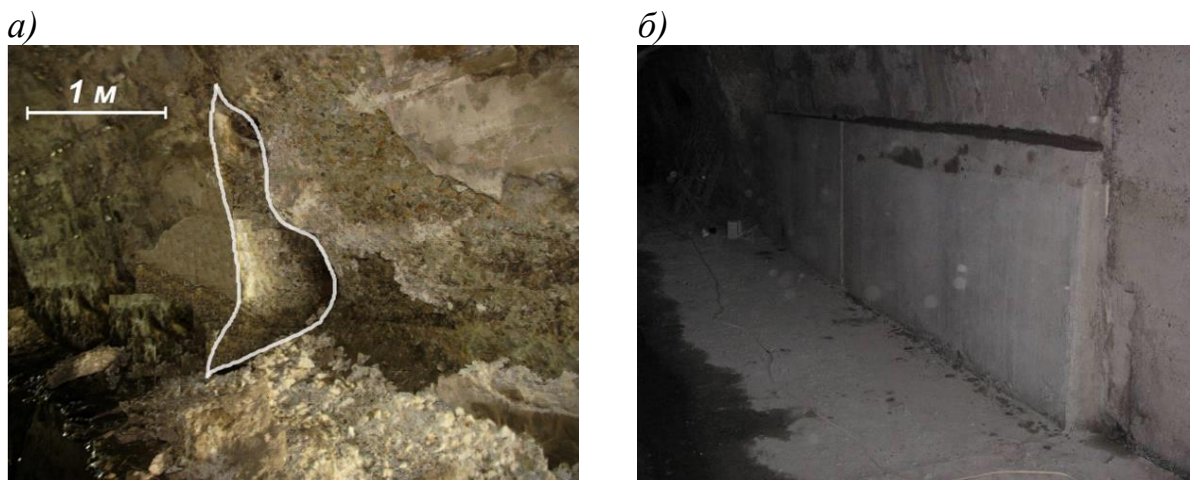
Водопропускна труба на 365 км ділянки Основа – Букине Південної залізниці: *а)* пошкодження бетонних стін з наскрізним вивалом; *б)* посилення стіни за допомогою залізобетонної обшивки з бетону оптимального складу з безосадової бетонної суміші, що вібророзтікається
